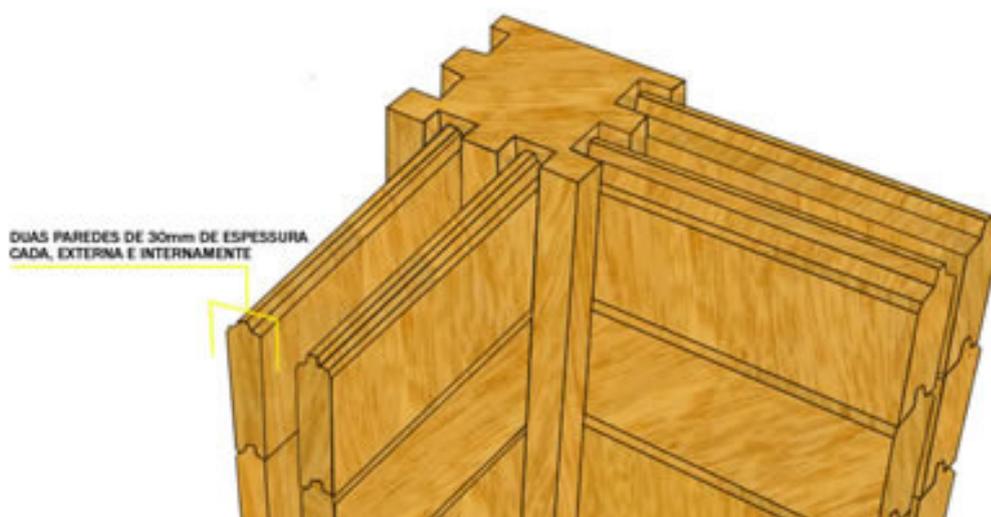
Detalhe de sistema construtivo com parede dupla em peça maciça de madeira. Fonte: PRECASA (2007).
